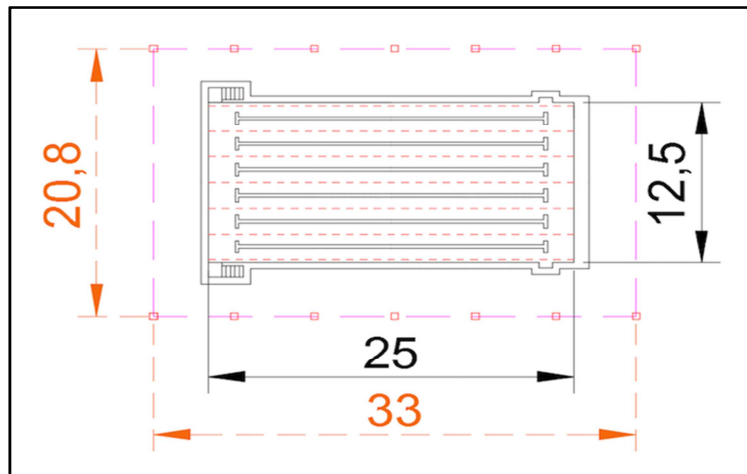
Detalles de las dimensiones de la construcción. Fuente: Elaboración propia con AutoCAD. Unidades en metros (m).
